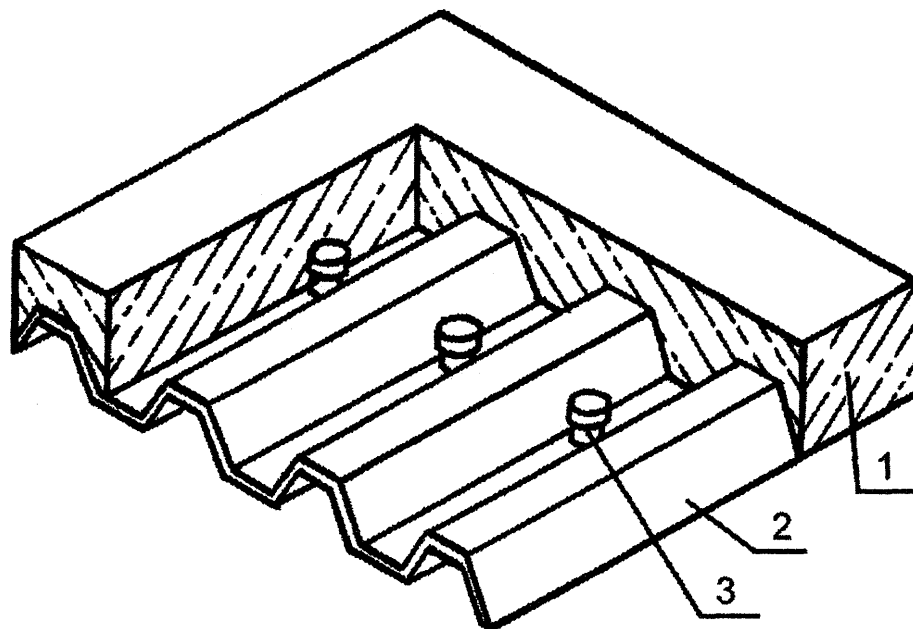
Конструкция междуэтажного перекрытия системы "VIP".
